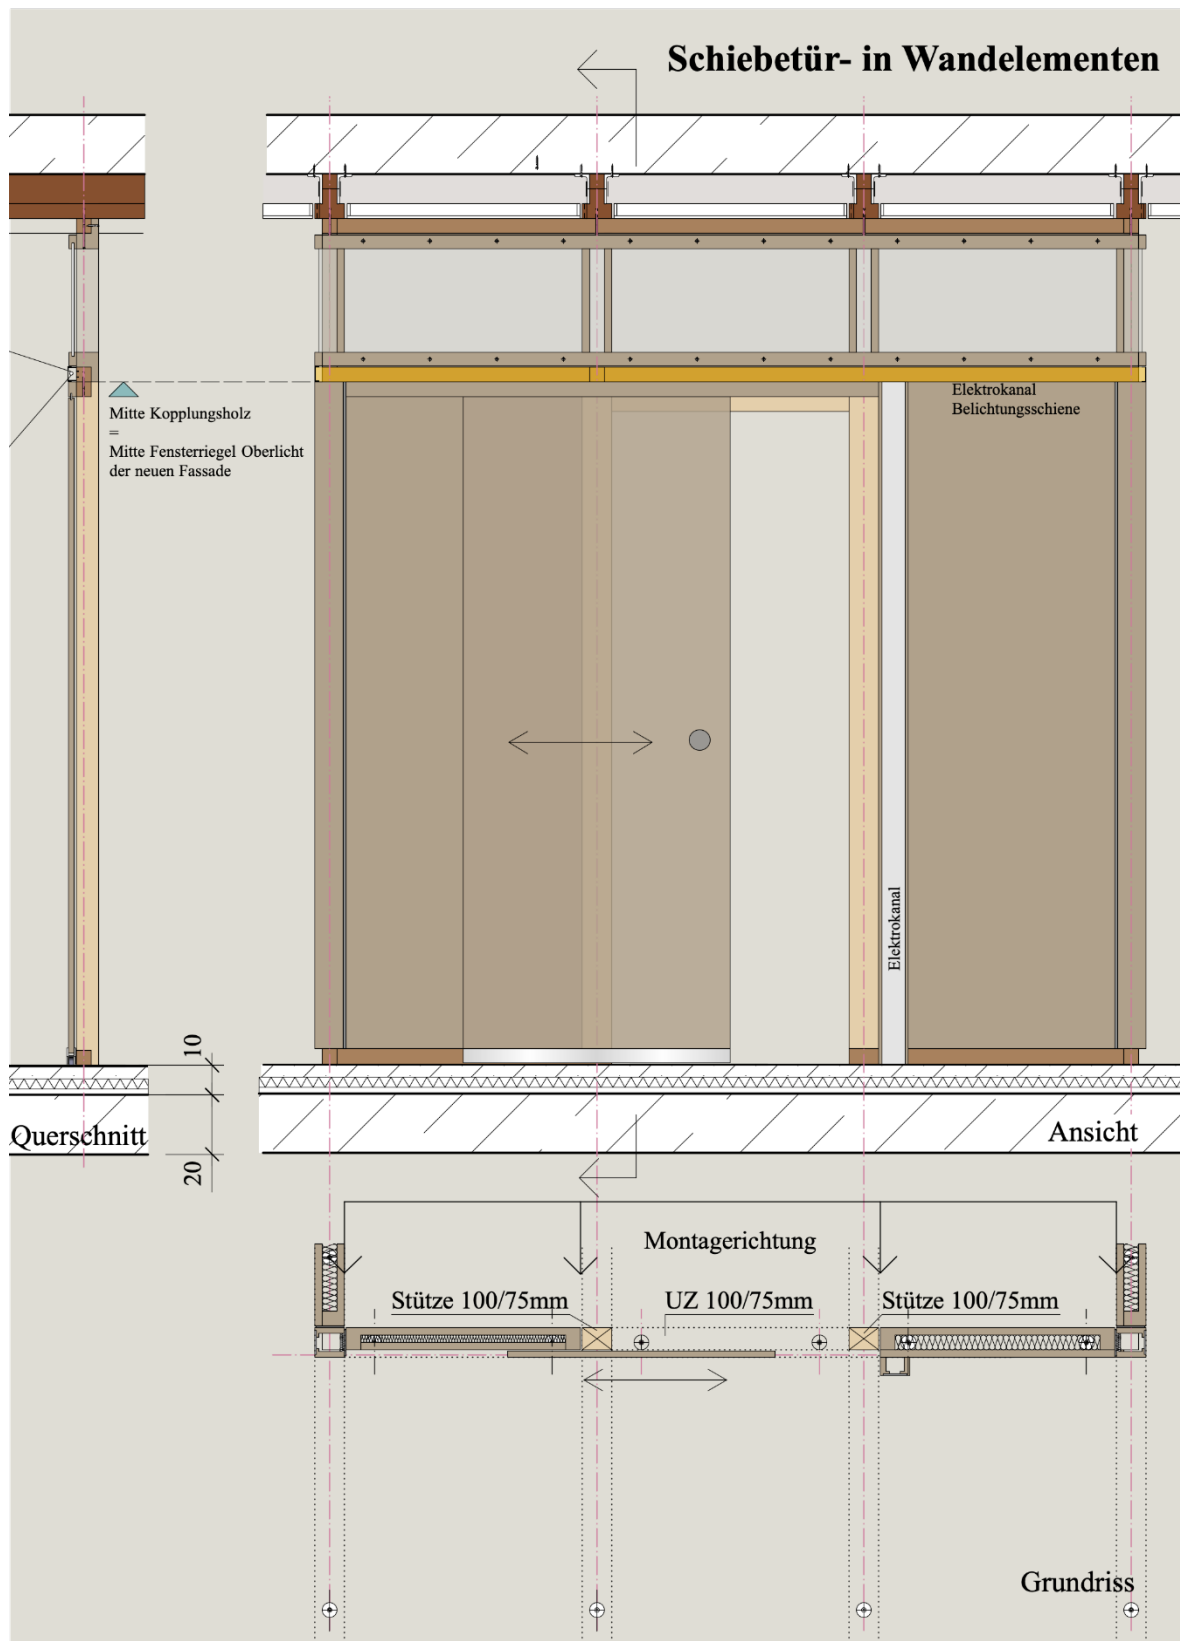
Darstellung Querschnitt/Ansicht/Grundriss - Einbau Schiebetür in Wandelement
